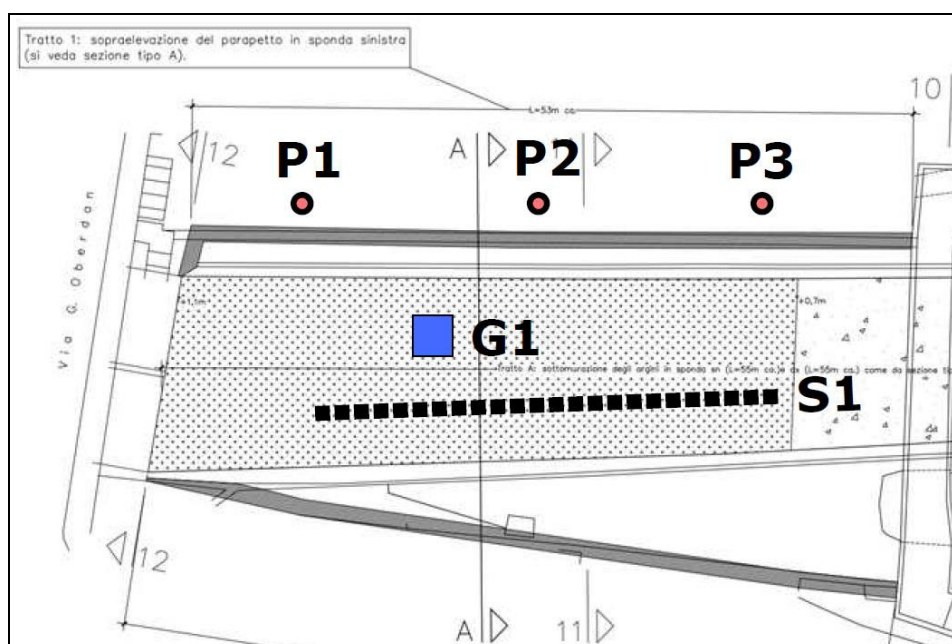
ubicazione prove P1,P2,P3 su stralcio planimetrico di progetto
